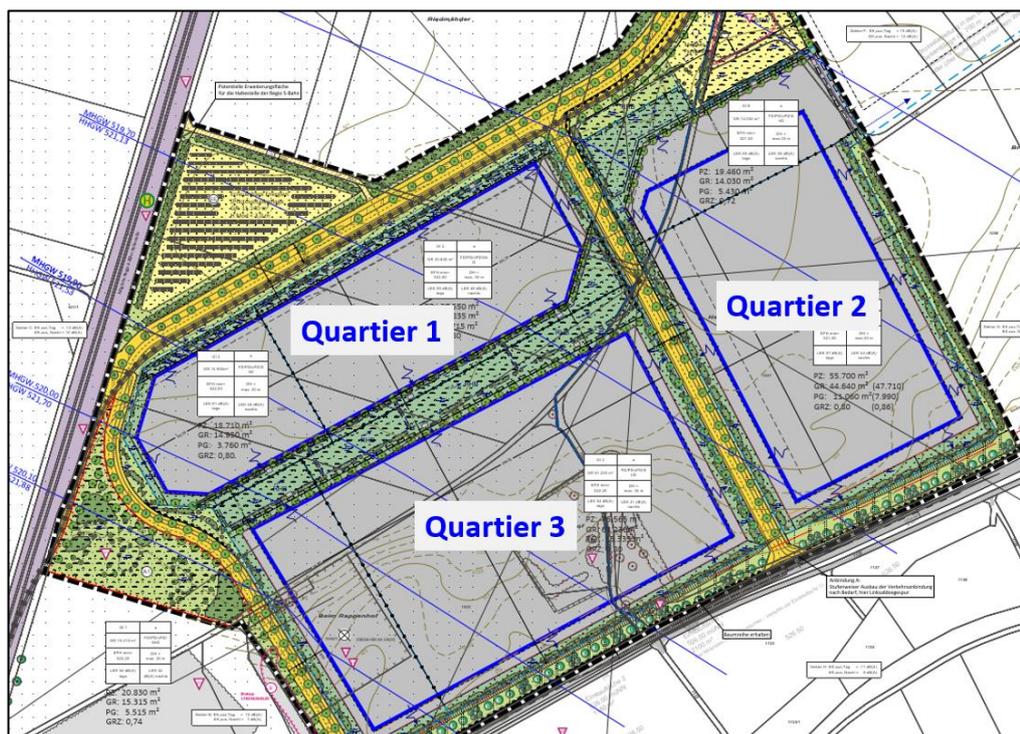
Lageplanausschnitt des Bebauungsplan und Darstellung der drei Quartiere für IGI Rißtal
